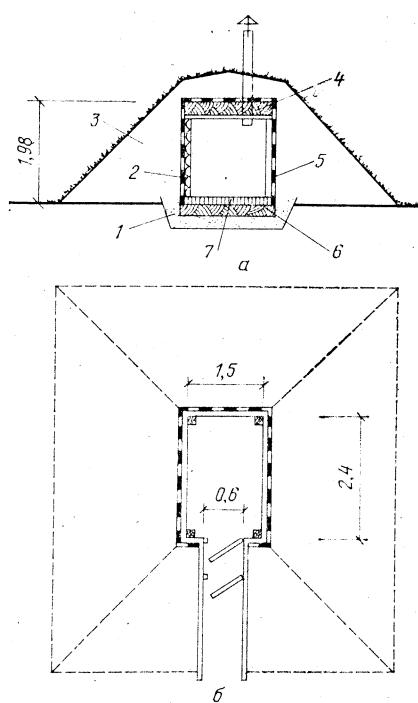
Наземный погреб с обваловкой: а — разрез; б — план; 1 — песчано-щебеночная подготовка; 2 — стены из горбыля; 3 — обваловка; 4 — глиносолома; 5 — гидроизоляция [пергамин]; 6 — глиняный замок; 7 — пол [кирпич на «ребро»]
